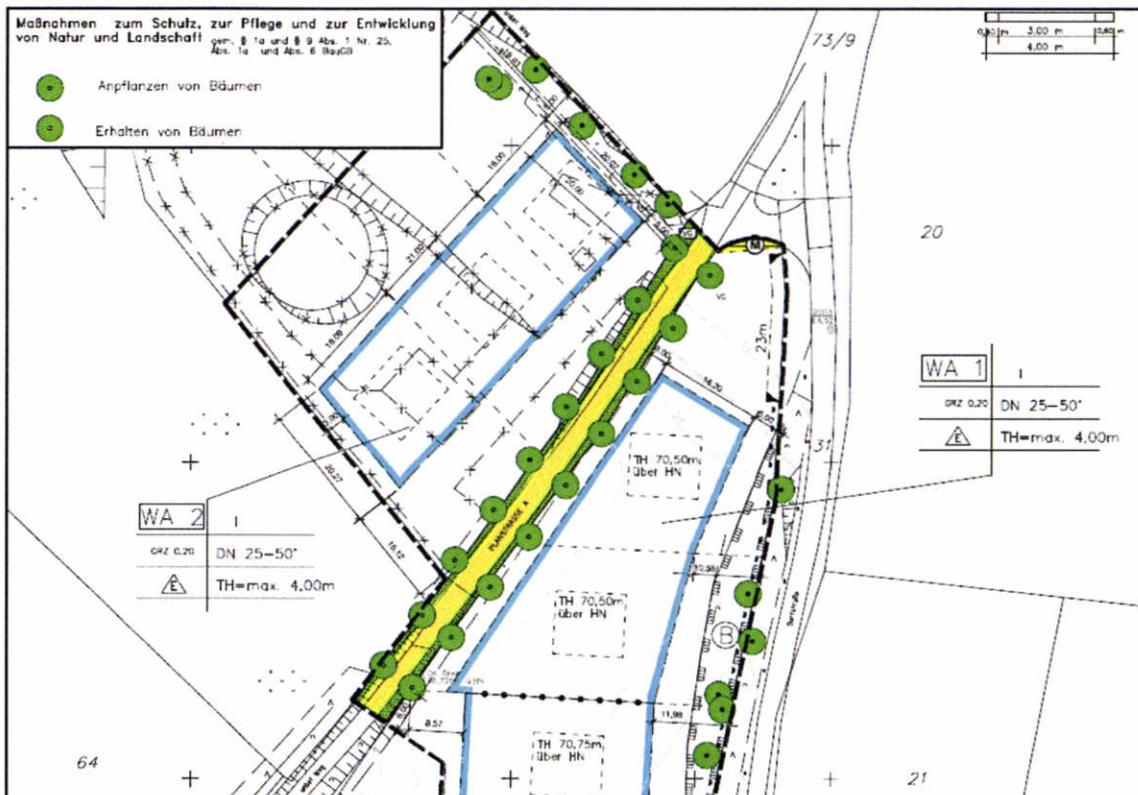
Ausschnitt Planzeichnung B-Plan mit Kennzeichnung zu erhaltender und neu zu pflanzender Bäume. Hiernach sind 17 Bäume entlang der Planstraße A neu zu pflanzen (1 Baum ist hier zu erhalten).
